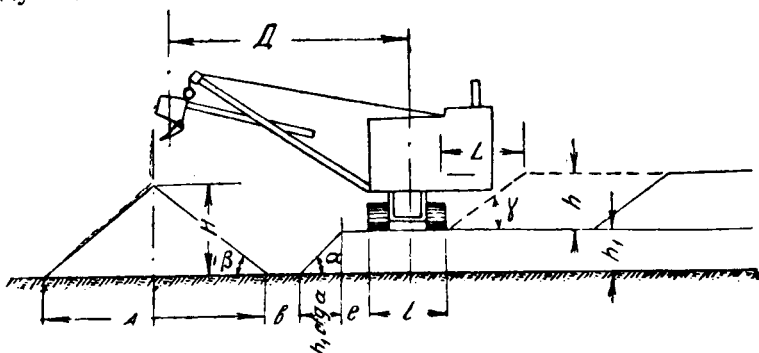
Схема разработки вскрыши механической лопатой с укладкой грунта в выработанный забой
